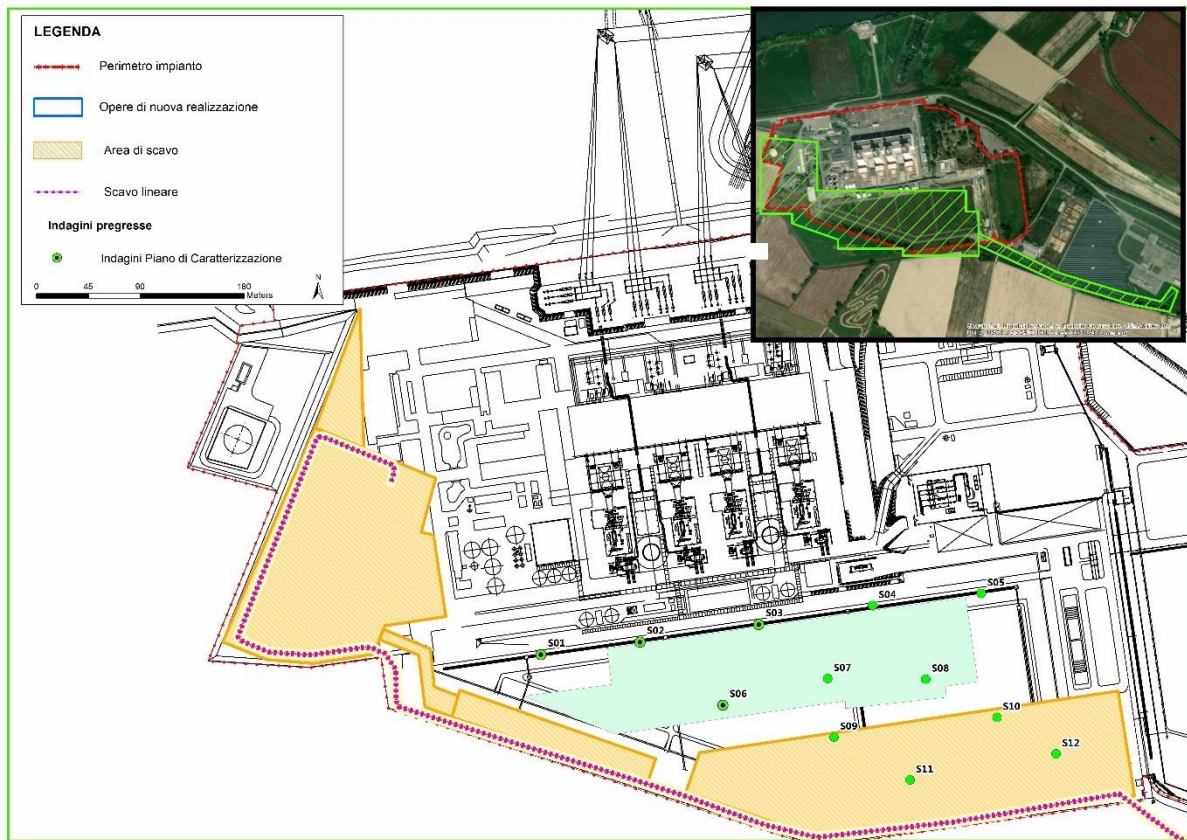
Indagini eseguite nel 2006 con indicazione del rilevato e dell'area di cantiere.
